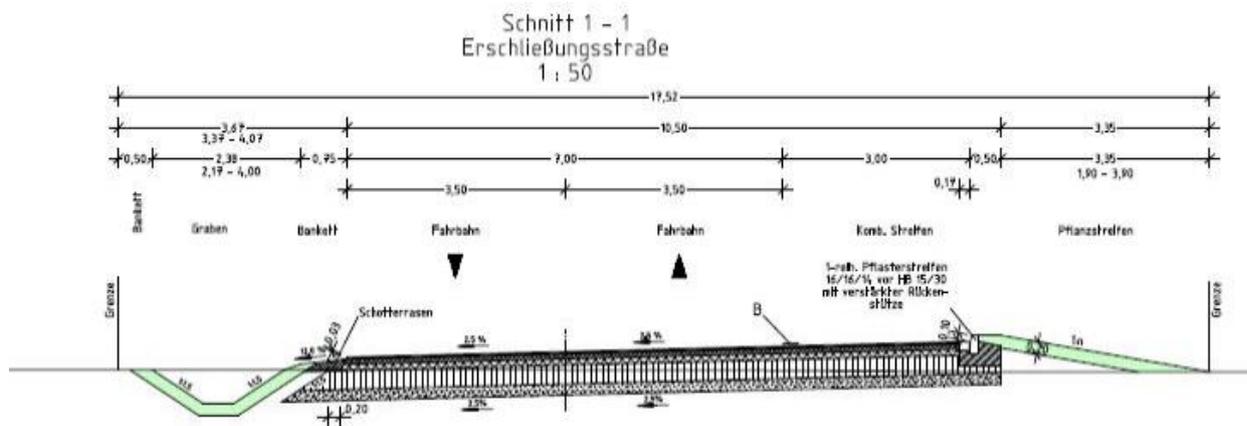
Straßenquerschnitt Verlängerung Hauptplanstr. / Abschnitt nördlich GE 1
